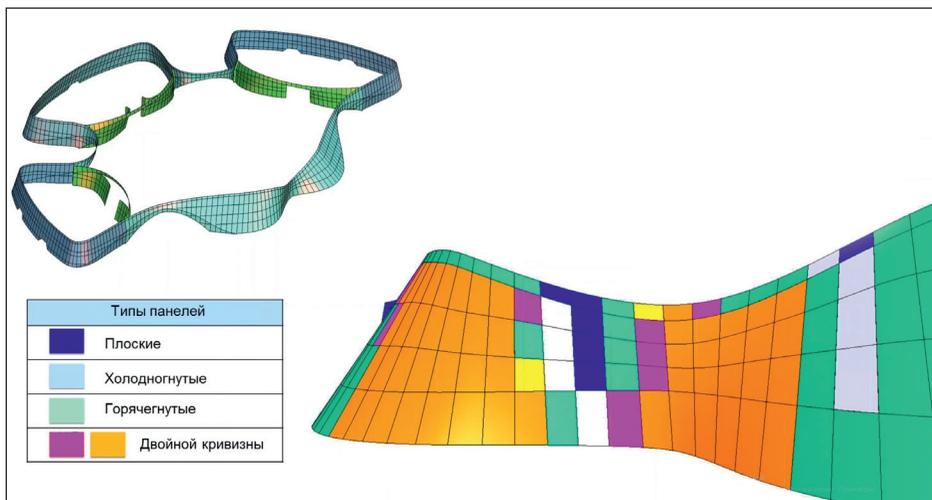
Оболочка здания с опорной сеткой для стеклопакетов
